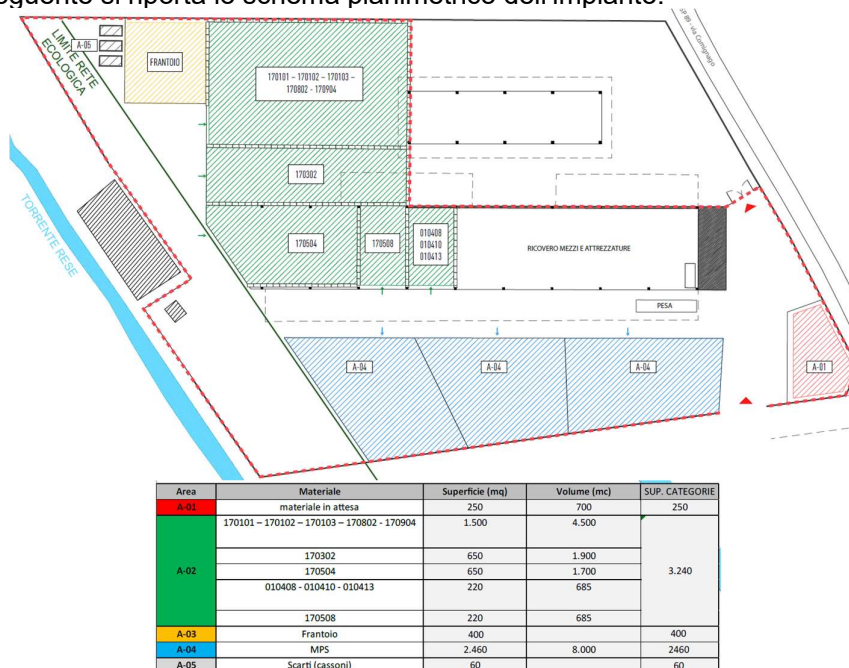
Planimetria dell'impianto (estratto tav.2 “Planimetria generale - suddivisione aree”)
